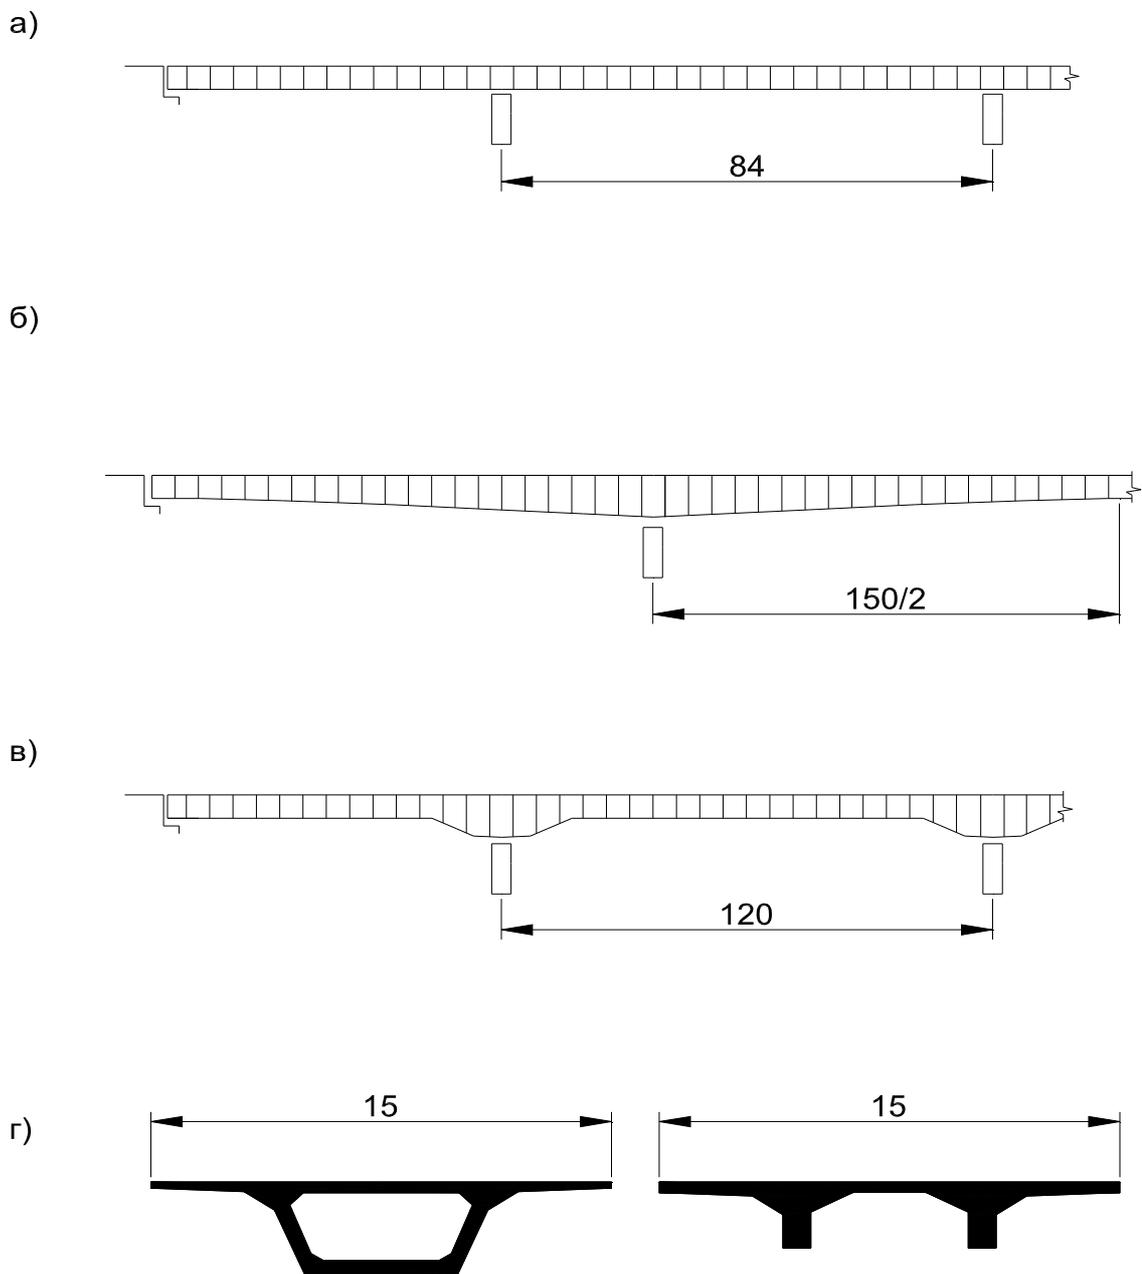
Системы железобетонных предварительно напряженных составных пролетных строений: а-с постоянной высотой; б-с переменной высотой; в-с увеличенной высотой у опор; г-поперечные сечения
